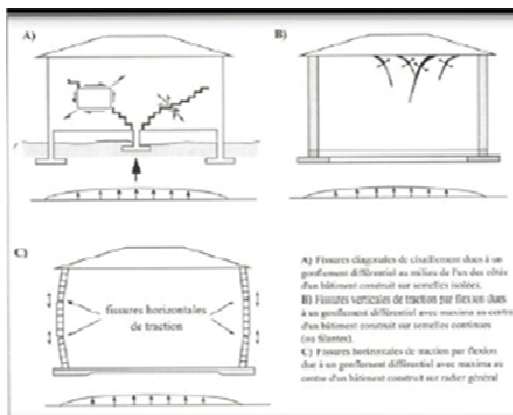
Formes de fissuration Sur des Bâtiments Reposant sur des terrains gonflants. Ferrah (2006)
